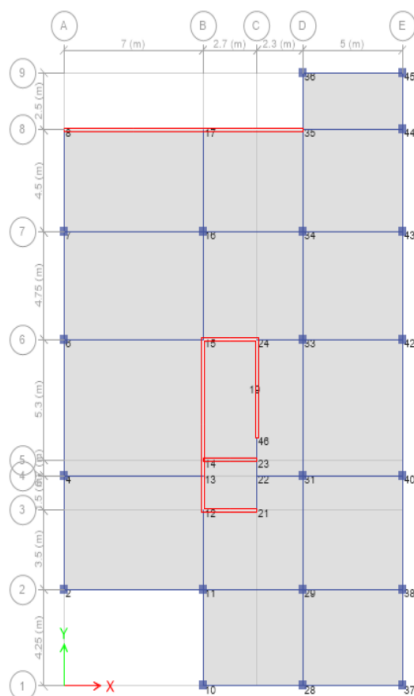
Planta Típica del desarrollo del proyecto (C0)
